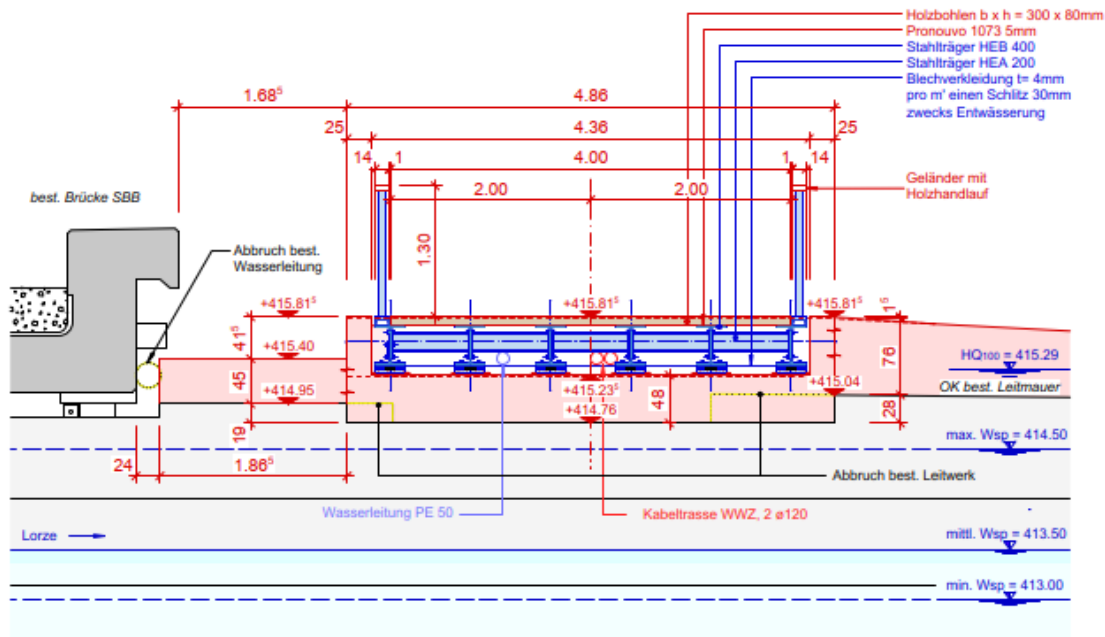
Querschnitt Radwegbrücke Brüggli Ost, Stand Bauprojekt (August 2024)
